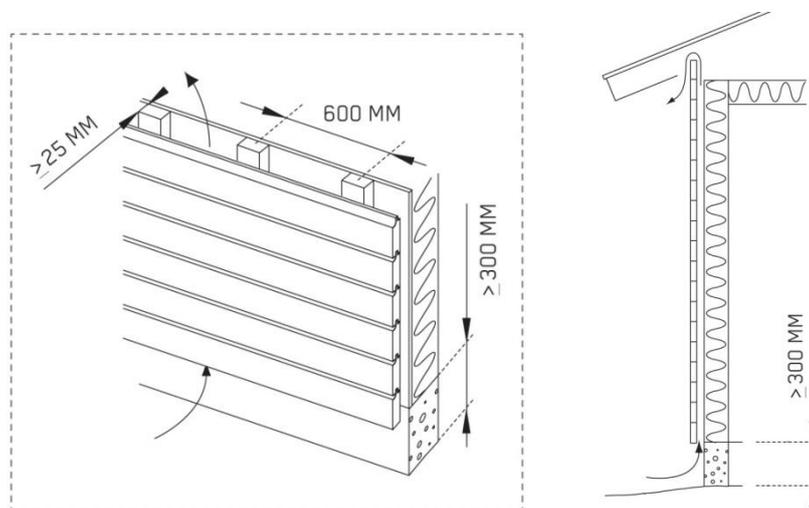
Esquema de Montagem da Madeira Tratada em Sistema de Fachada Ventilada ⁶⁰
